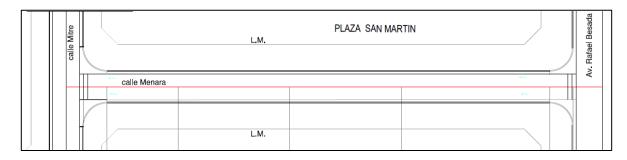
Planta tramo calle Menara entre Mitre y Besada (s/proyecto de CAFESG)
